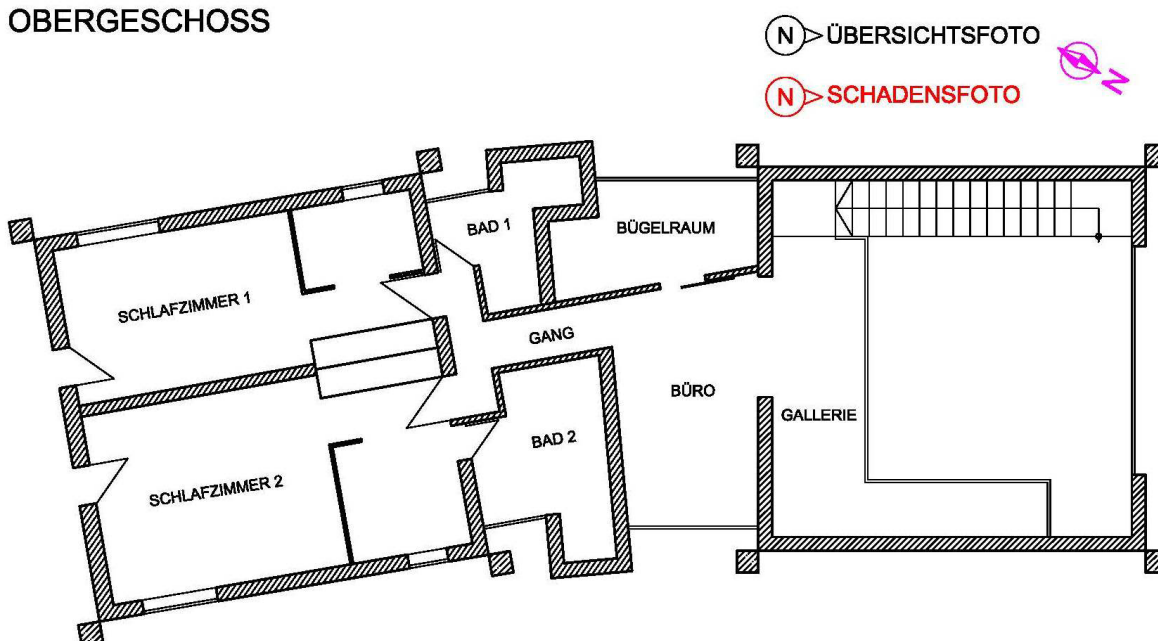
Beispiel einer CAD mäßigen Aufbereitung eines Grundrissplanes
